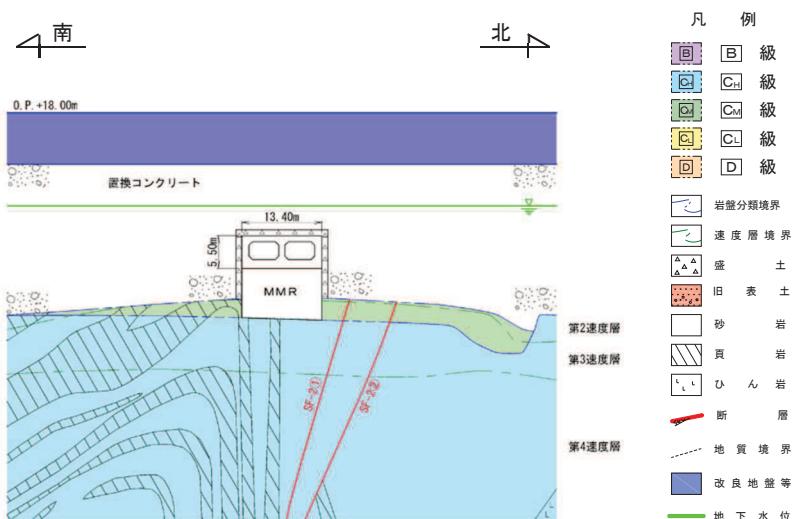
(3) 取水路（標準部） 地震時荷重算出断面図（断面④：直線部）
